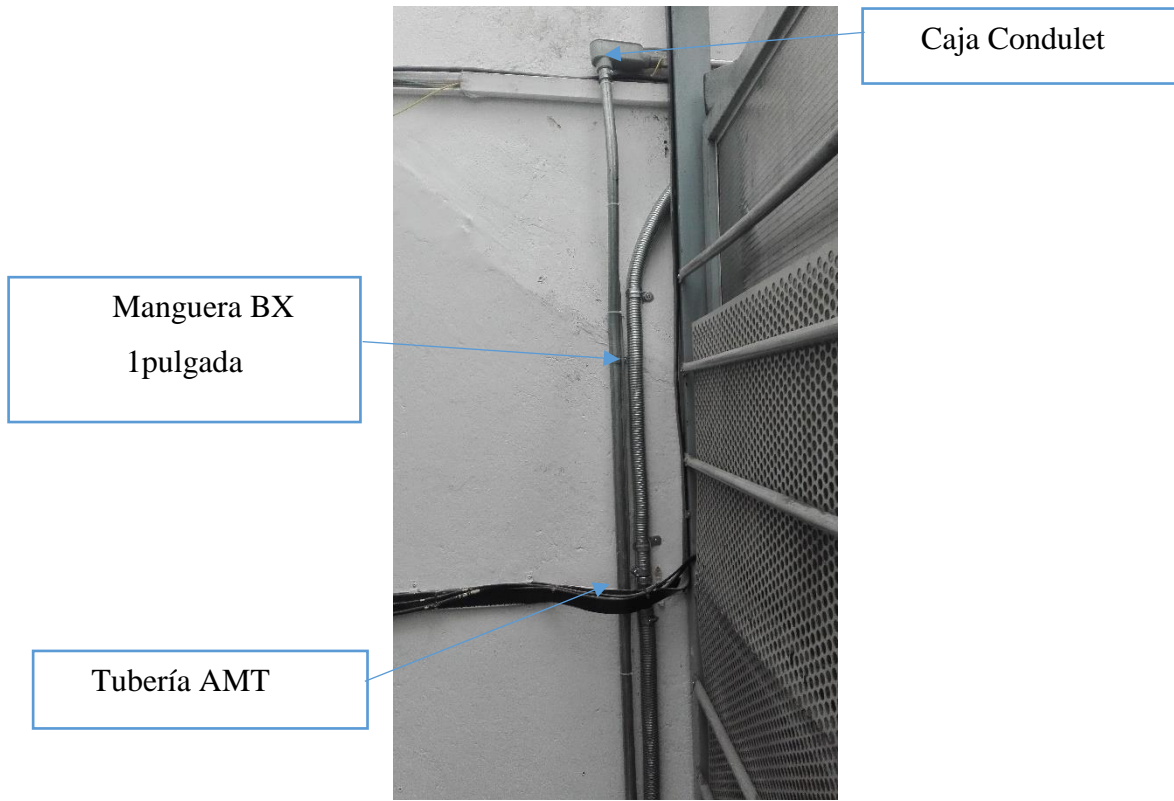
Instalación de tubería y manguera BX Planta Baja.
